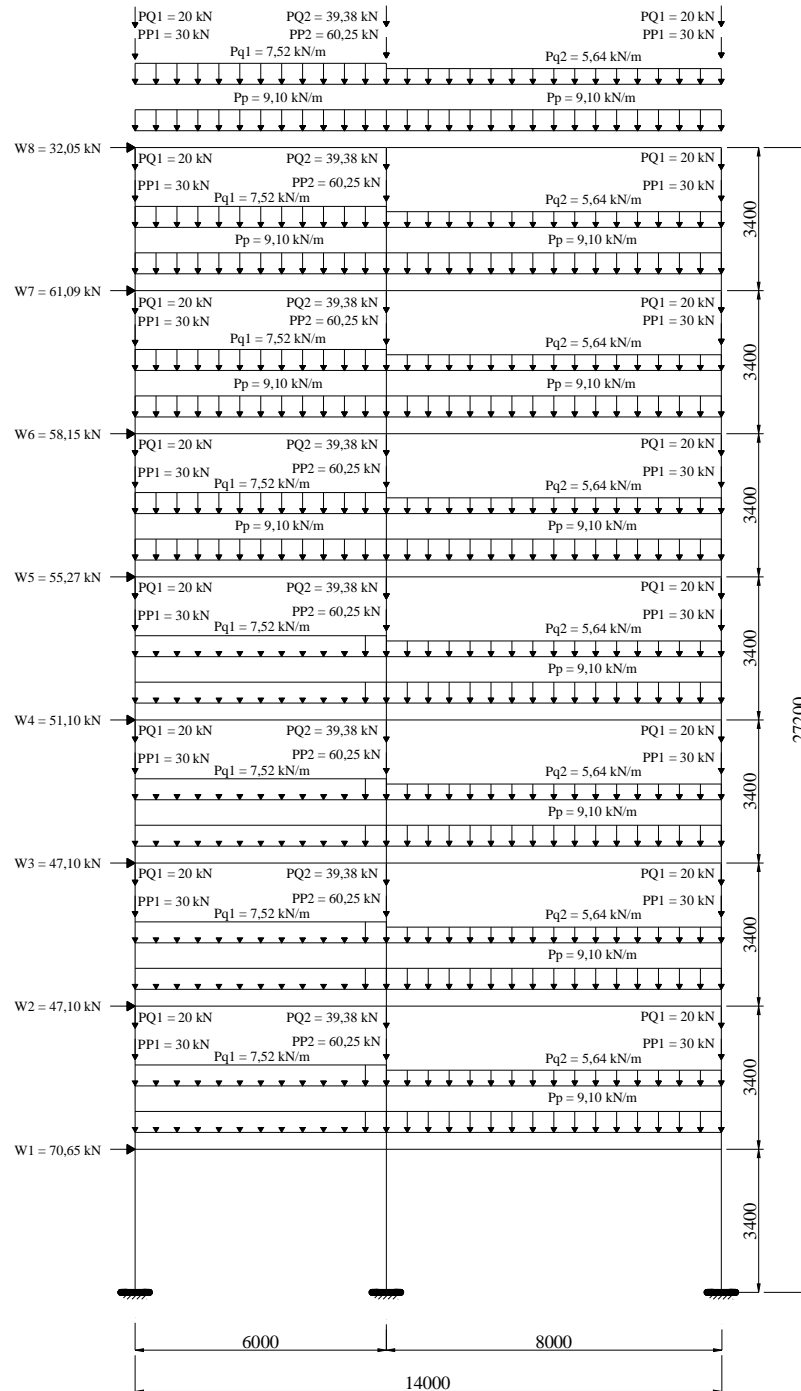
Pórtico rígido de oito pavimentos (dimensões em milímetros e ações com valores característicos)
